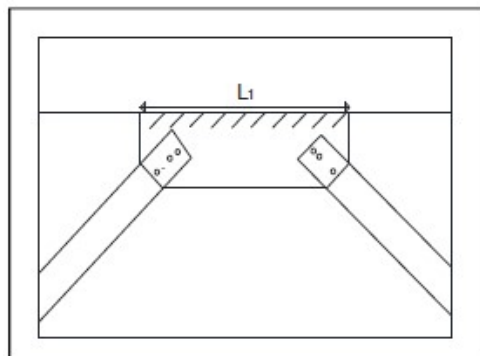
Cordons de soudure gousset de la sablière HEA120.
